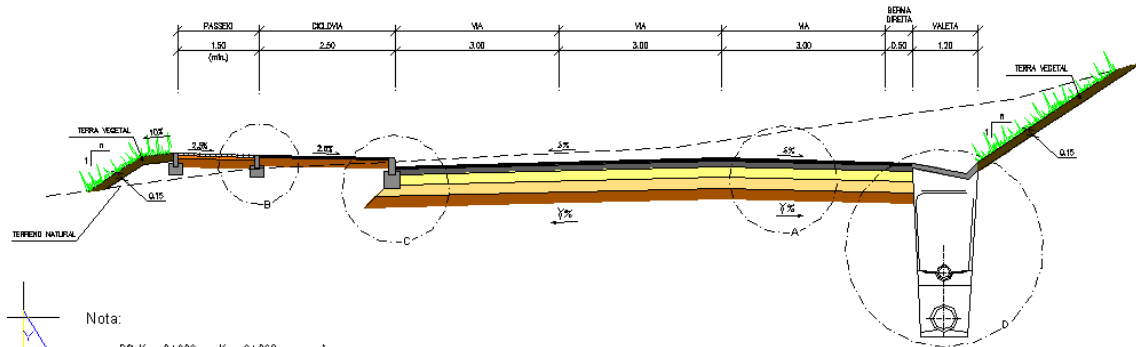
Perfil Transversal Tipo do troço entre o início e o Cruzamento FT.1
